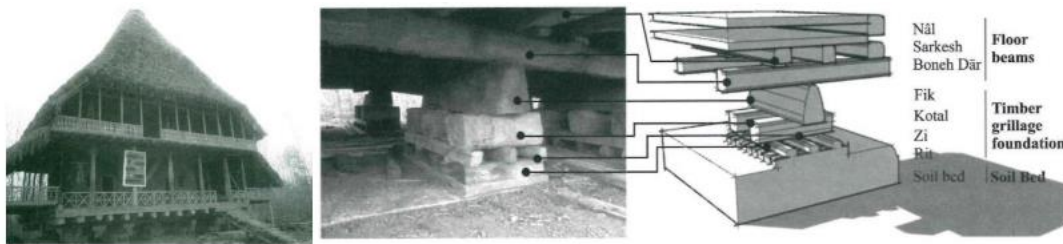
Aislamiento en base a grillas de madera, Irán.
